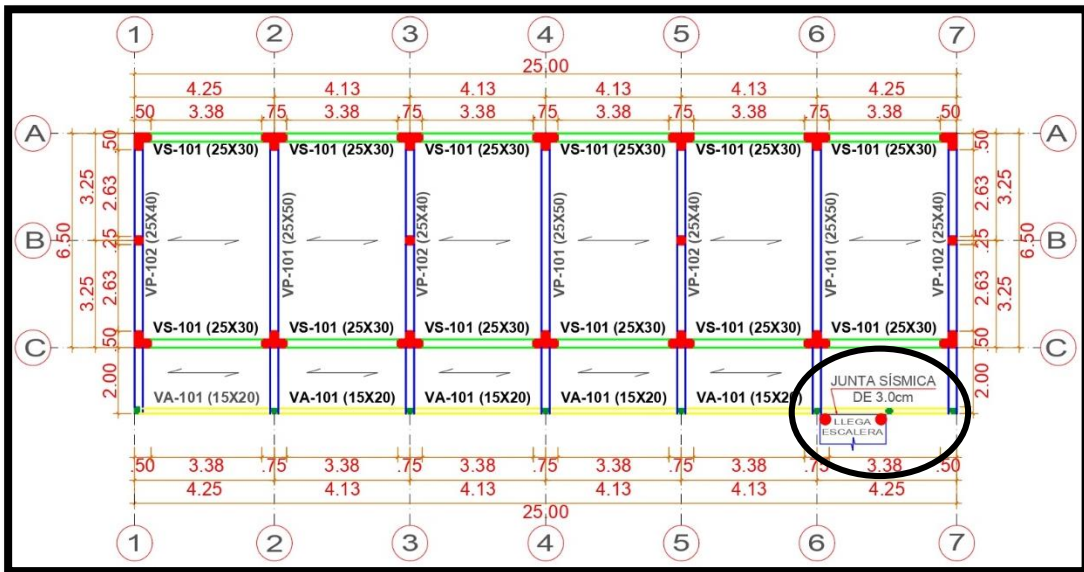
Plano de losa aligerada de 1° piso _Módulo VI; ubicación de la escaleras.
